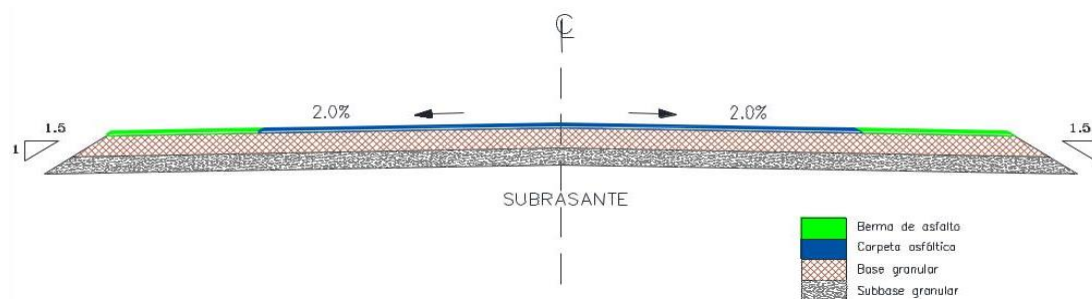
Sección típica pavimento flexible (Fuente: Elaboración propia)
